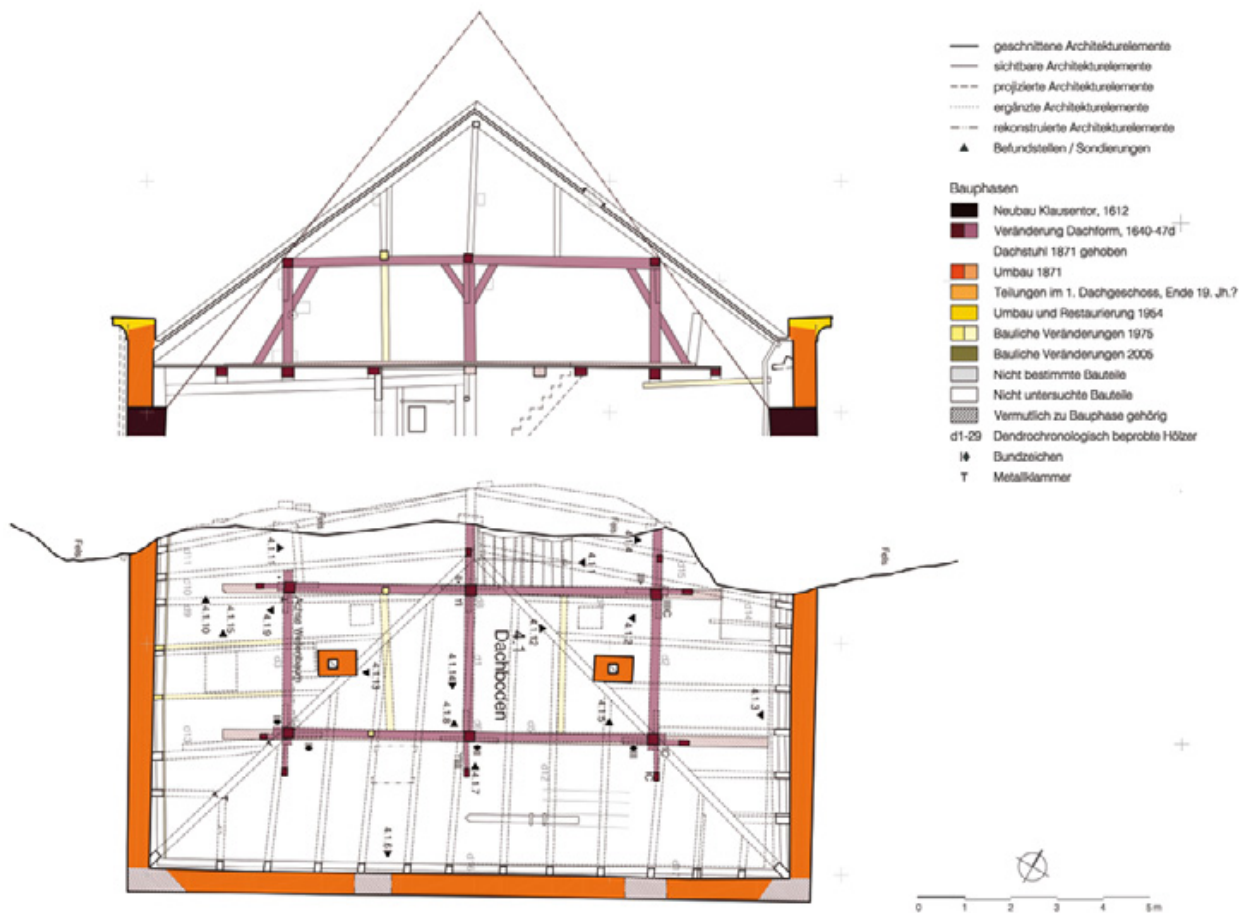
Salzburg, Klausentor. Schnitt durch den Dachbereich (oben) und Baualterplan des 2. Dachgeschosses (unten).
